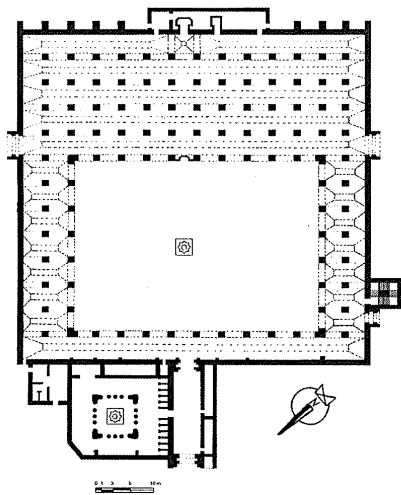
مسقط أفقى لجامع تازة الموحدى.
